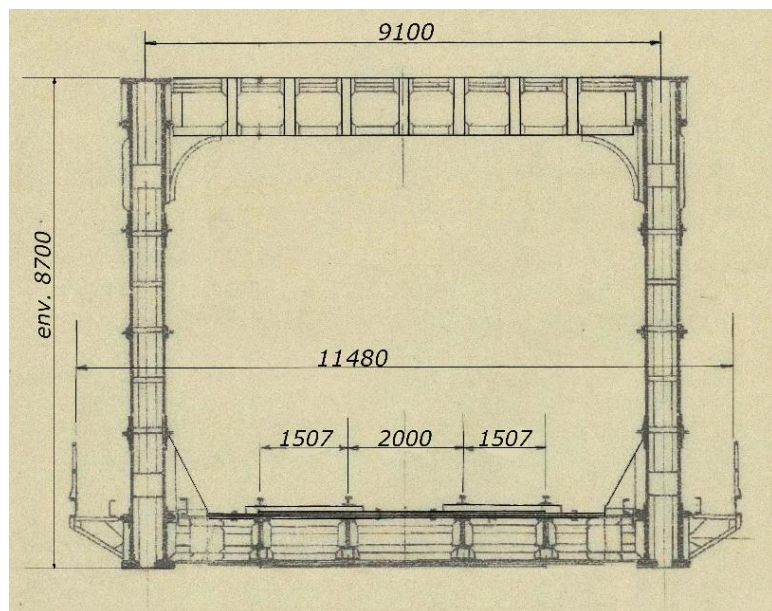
Coupe transversale à mi-longueur du pont (d'après les plans SNCB¹¹)
